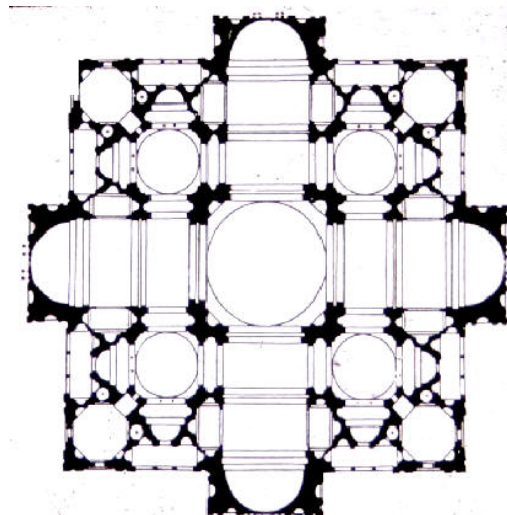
Planta arquitectónica del proyecto presentado por Bramante para la Basílica San Pedro.
